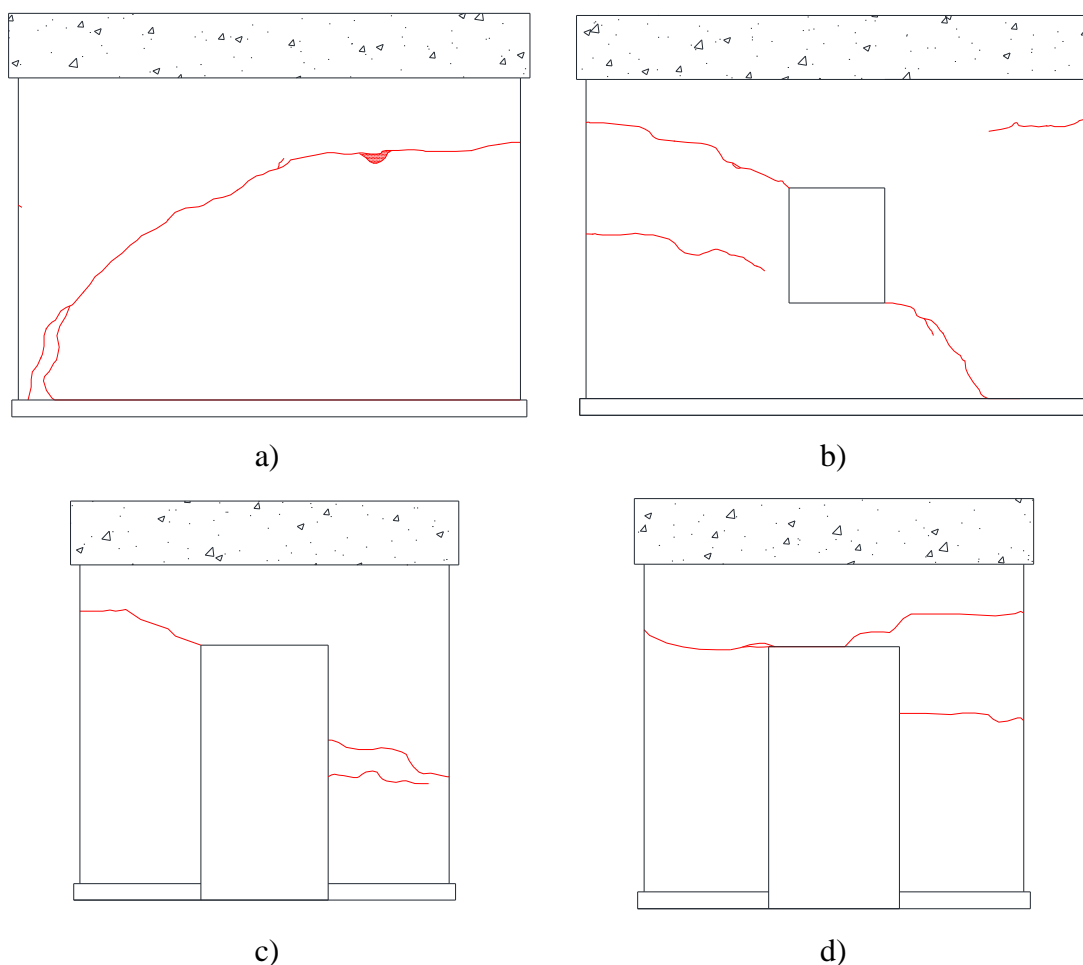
Fissuração após o ensaio monotónico: a) Fachada Norte b) Fachada Sul c) Fachada Oeste d) Fachada Este (Carvalho, 2013)
